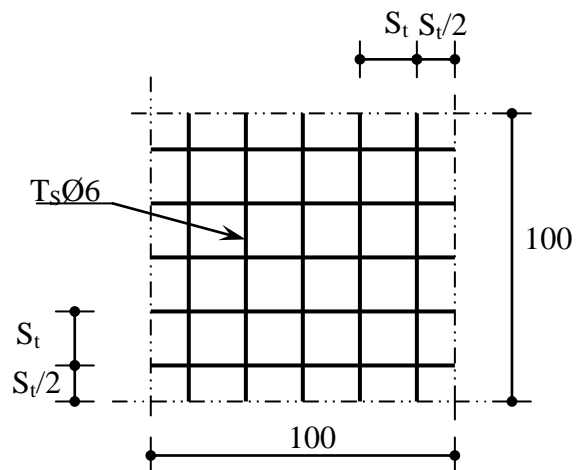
Disposition constructive des armatures de la dalle de compression
